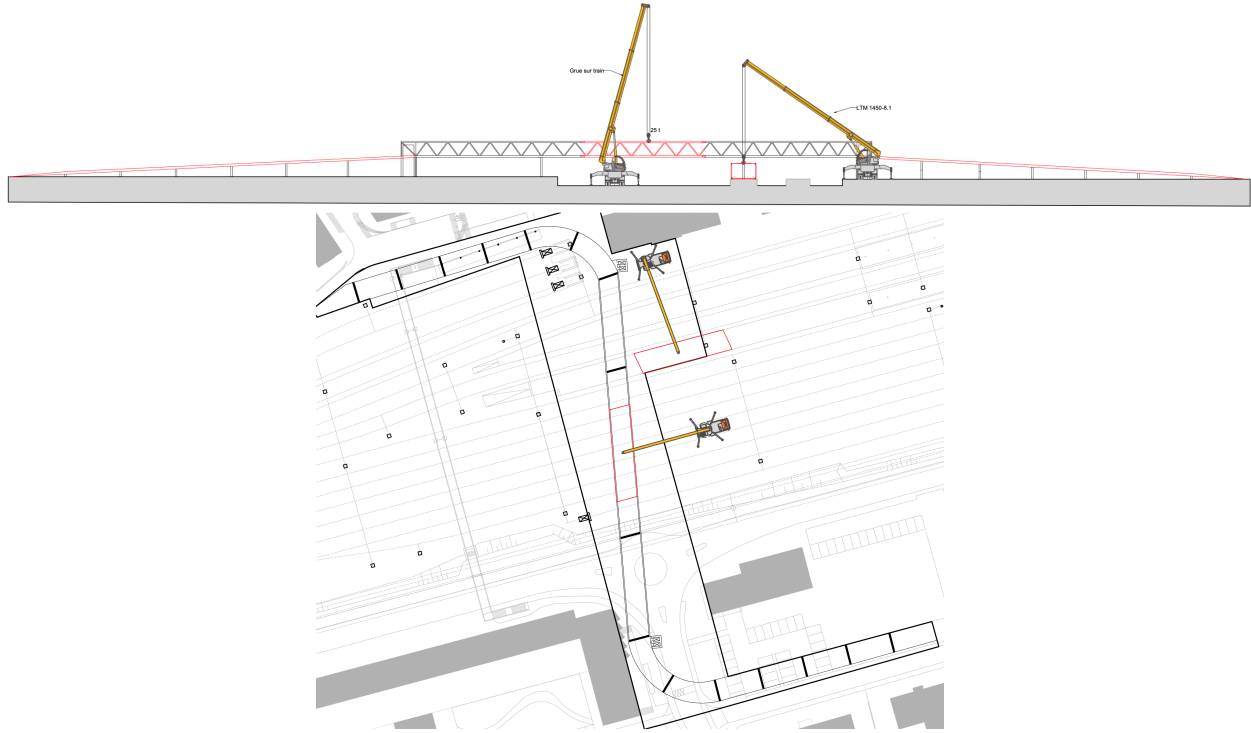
Étape 5 : Montage tronçon 5, bétonnage rampe
